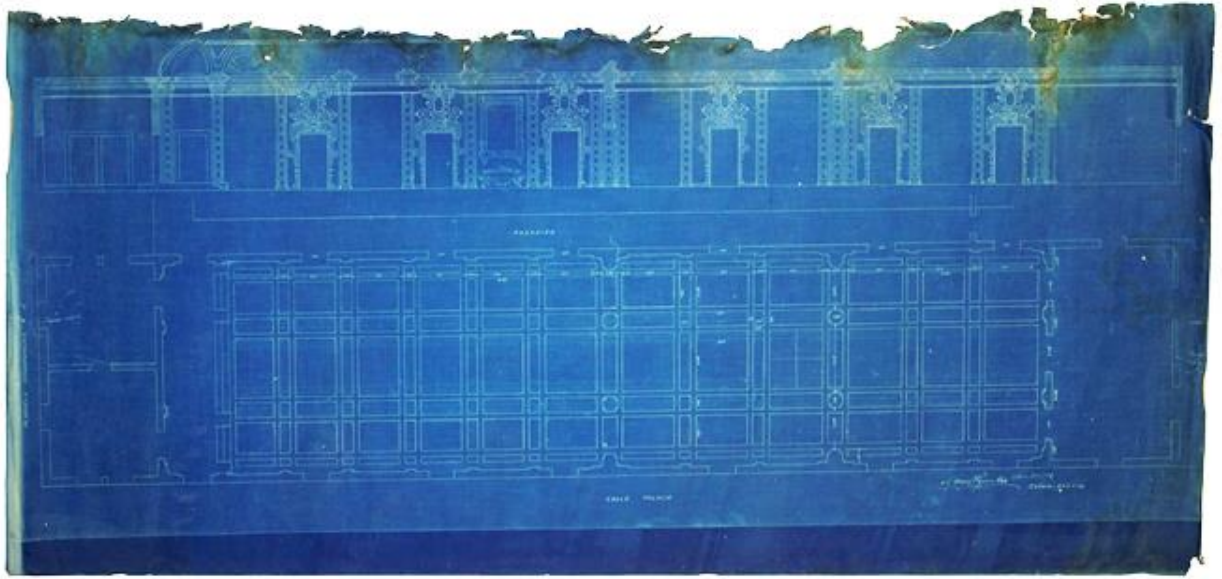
Piqueras Cotoí, Plano de planta del Salón. En el plano es posible ver el nombre de las calles donde estaba ubicado el salón: Palacio (centro inferior del plano) y Desamparados (extremo izquierdo del plano) así como un pasadizo que colindaba con un jardín interno de Palacio. Se aprecia también el diseño de las puertas con sus rosetones, el espacio destinado a las sargas e incluso el mobiliario. Ayacucho. Archivo Piqueras Cotoí, Museo de Arte de Lima.
